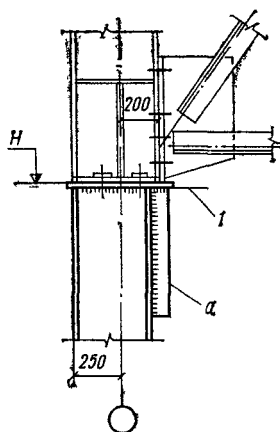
Оголовок колонны крайнего ряда кранового здания
